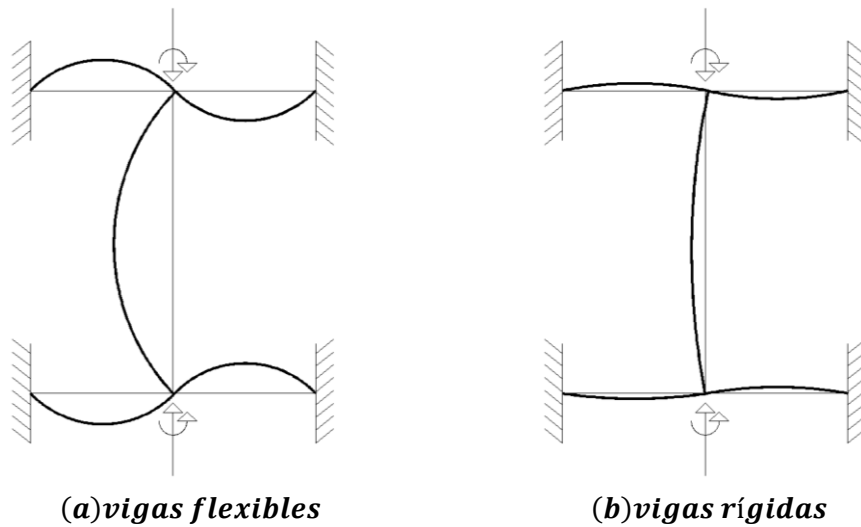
Efecto de la rigidez flexionante de las vigas que restringen a una columna
